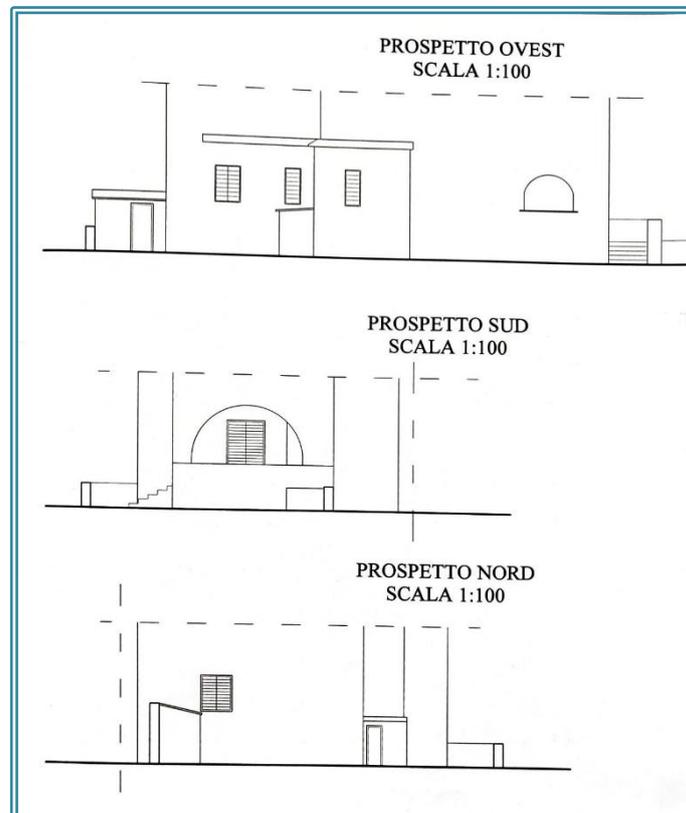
Prospetti – P.d.C. in sanatoria n. 08/17
